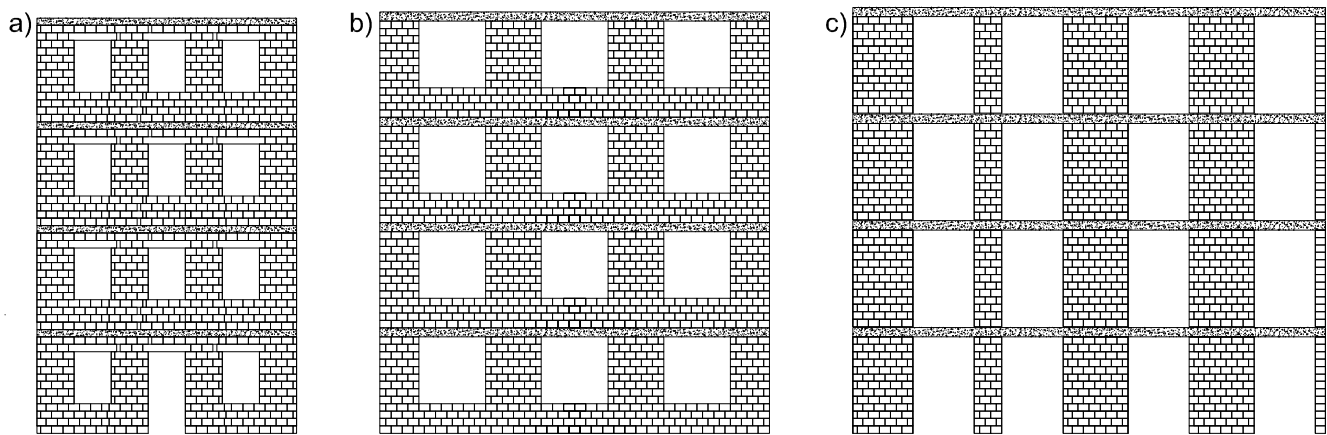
Fassaden von Mauerwerksgebäuden mit Stahlbetondecken mit unterschiedlichen Riegeltypen: Riegel aus Mauerwerk, Stahlbetondecke und Fenstersturz (a), aus Mauerwerk und Stahlbetondecke (b) und aus lediglich einer Stahlbetondecke (c).
